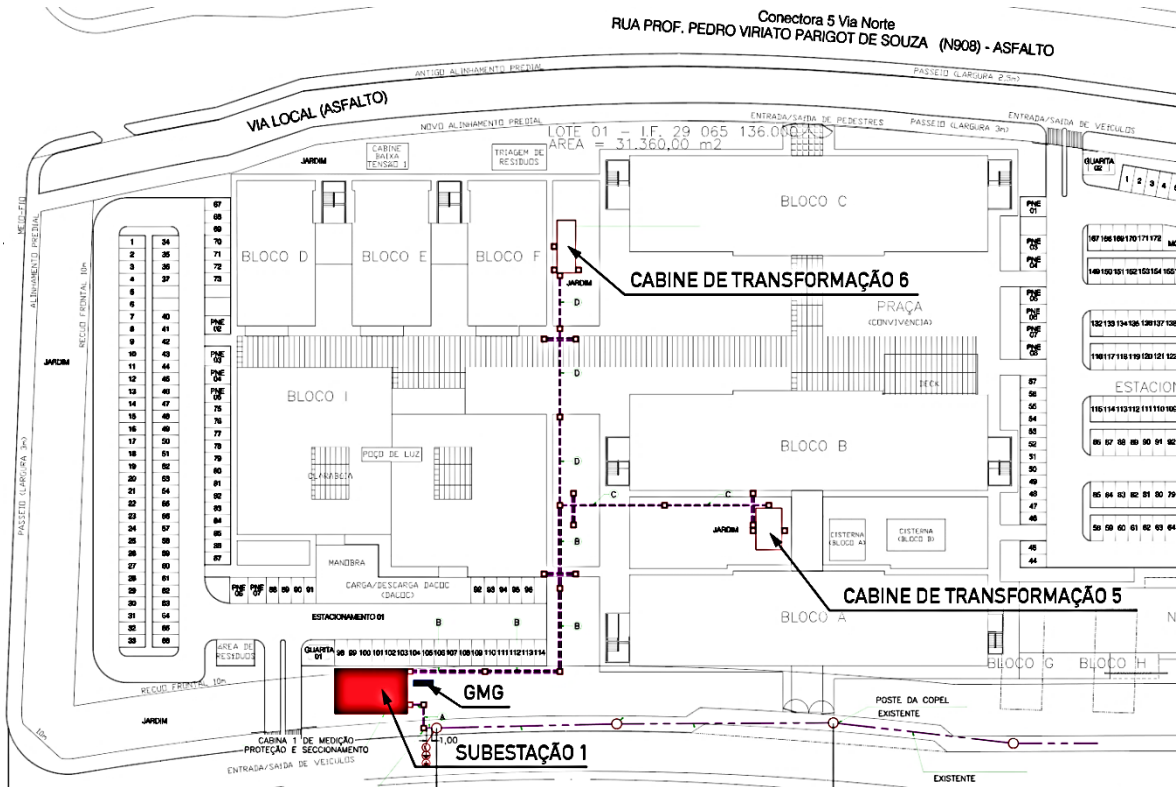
Planta Câmpus UTFPR Ecoville – Detalhes dos ramais de alimentação e localização do GMG.
